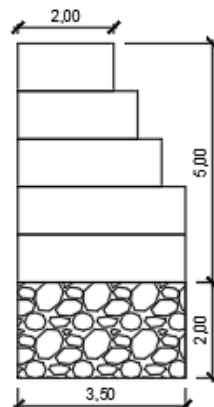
Sección transversal muro San Jerónimo. Elaboración propia
